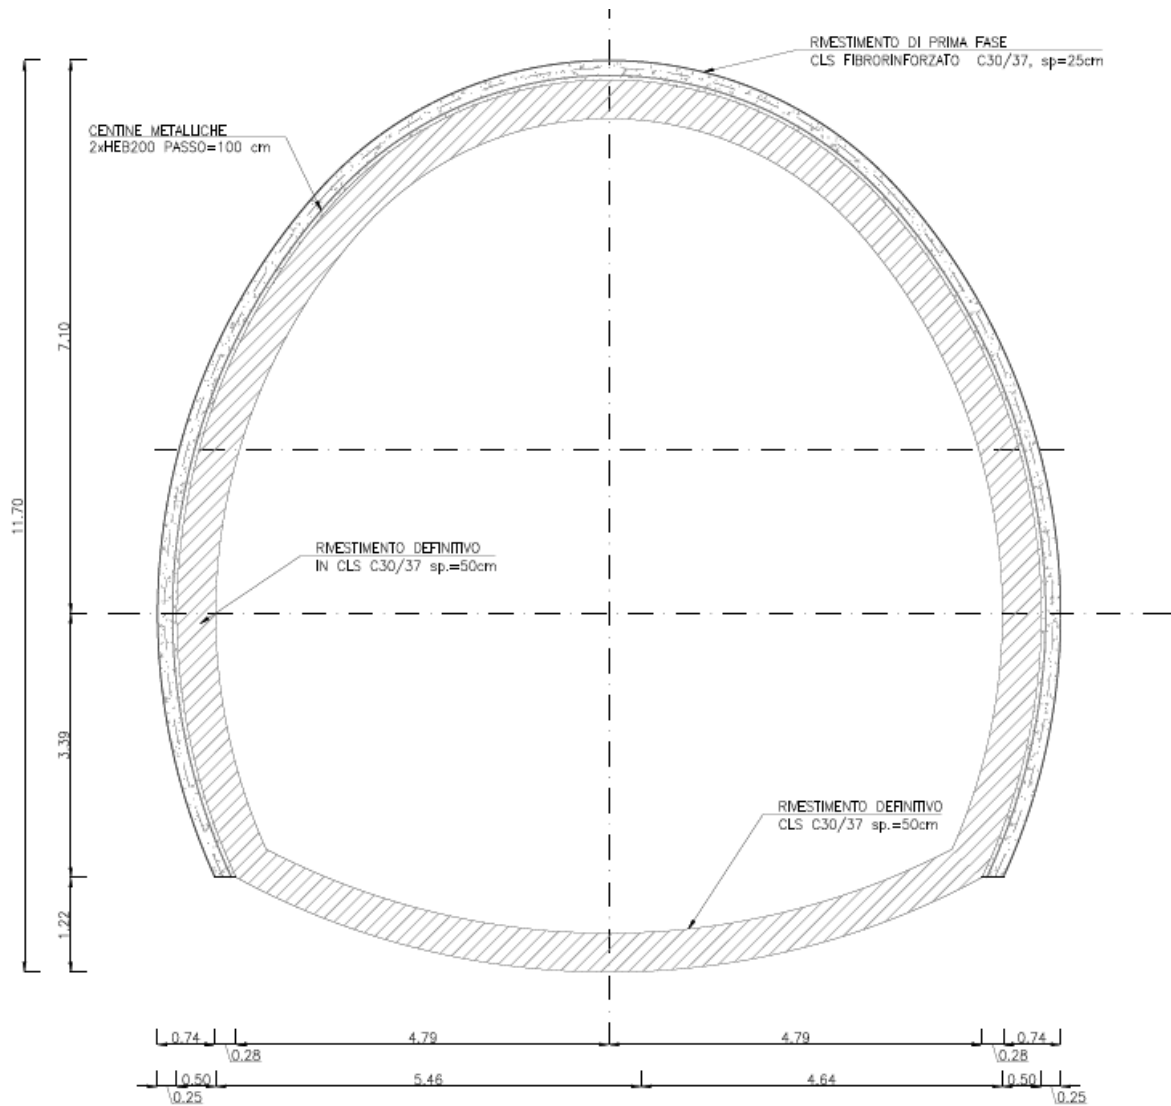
Sezione tipo SGC3: geometria del cavo e interventi di sostegno
